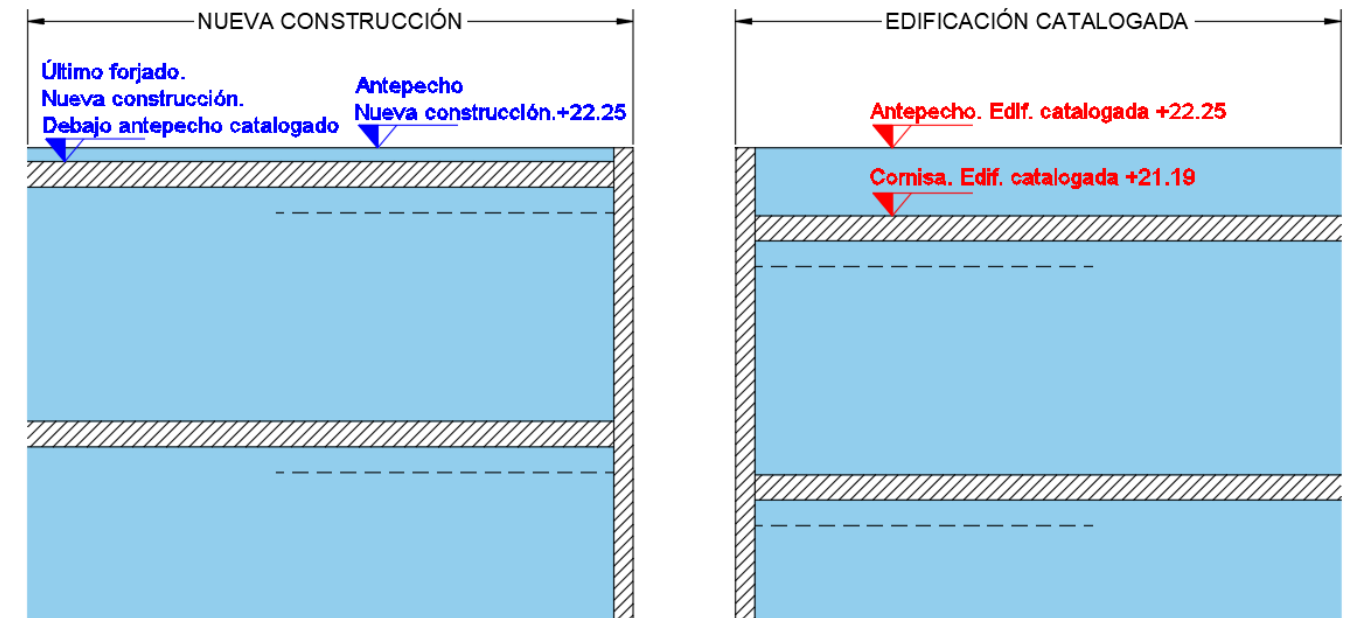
Sección Nueva construcción-Edificación catalogada
